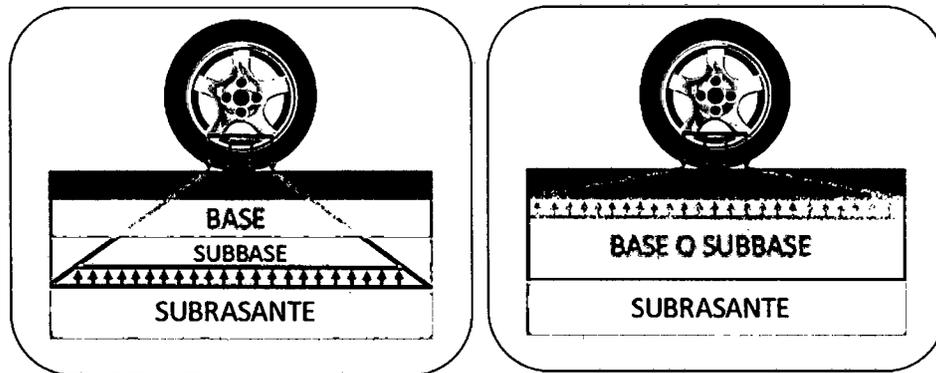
Comportamiento del pavimento frente a cargas de tránsito.
